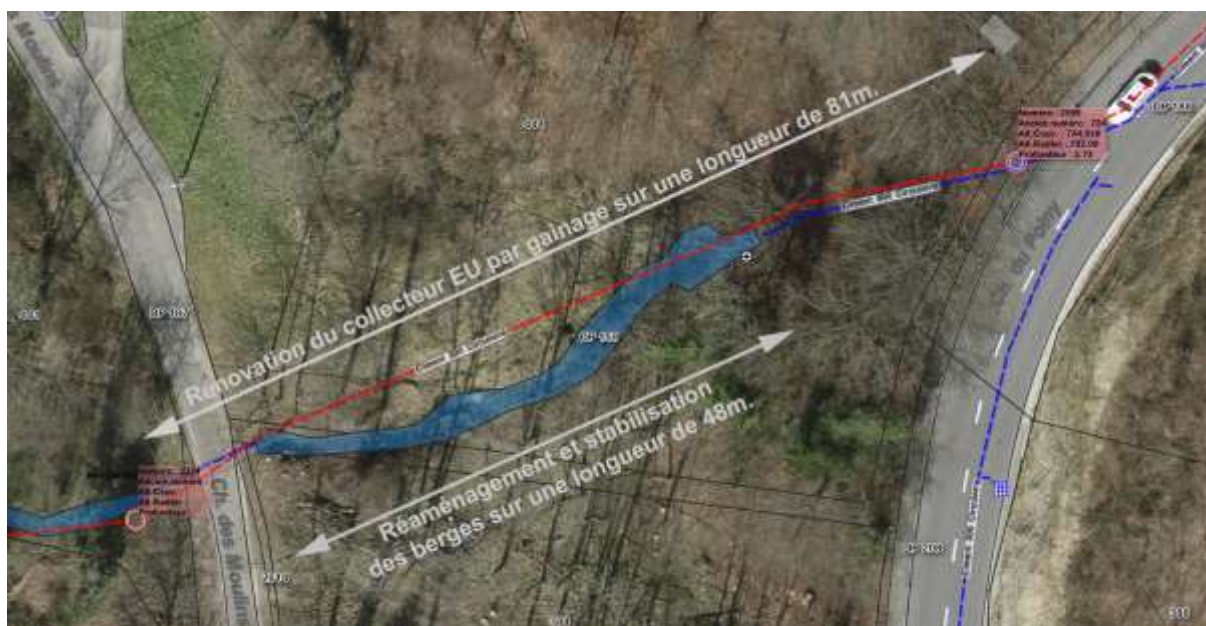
Plan de situation du secteur concerné par les travaux projetés
